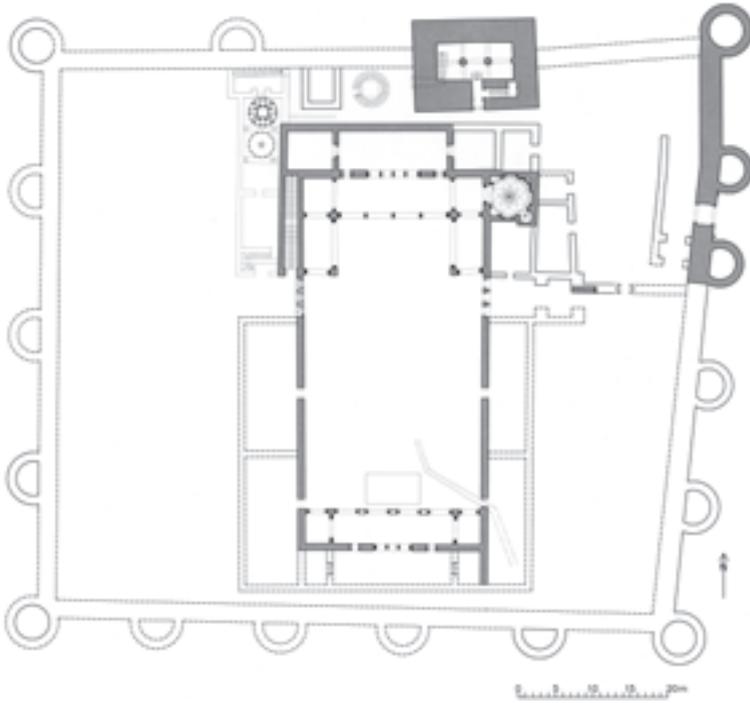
Reconstitución hipotética del plano de planta del palacio islámico de la Aljafería. Plano realizado en el estudio de arquitectura de José Javier Aguirre a partir de un plano de planta de Christian Ewert.
